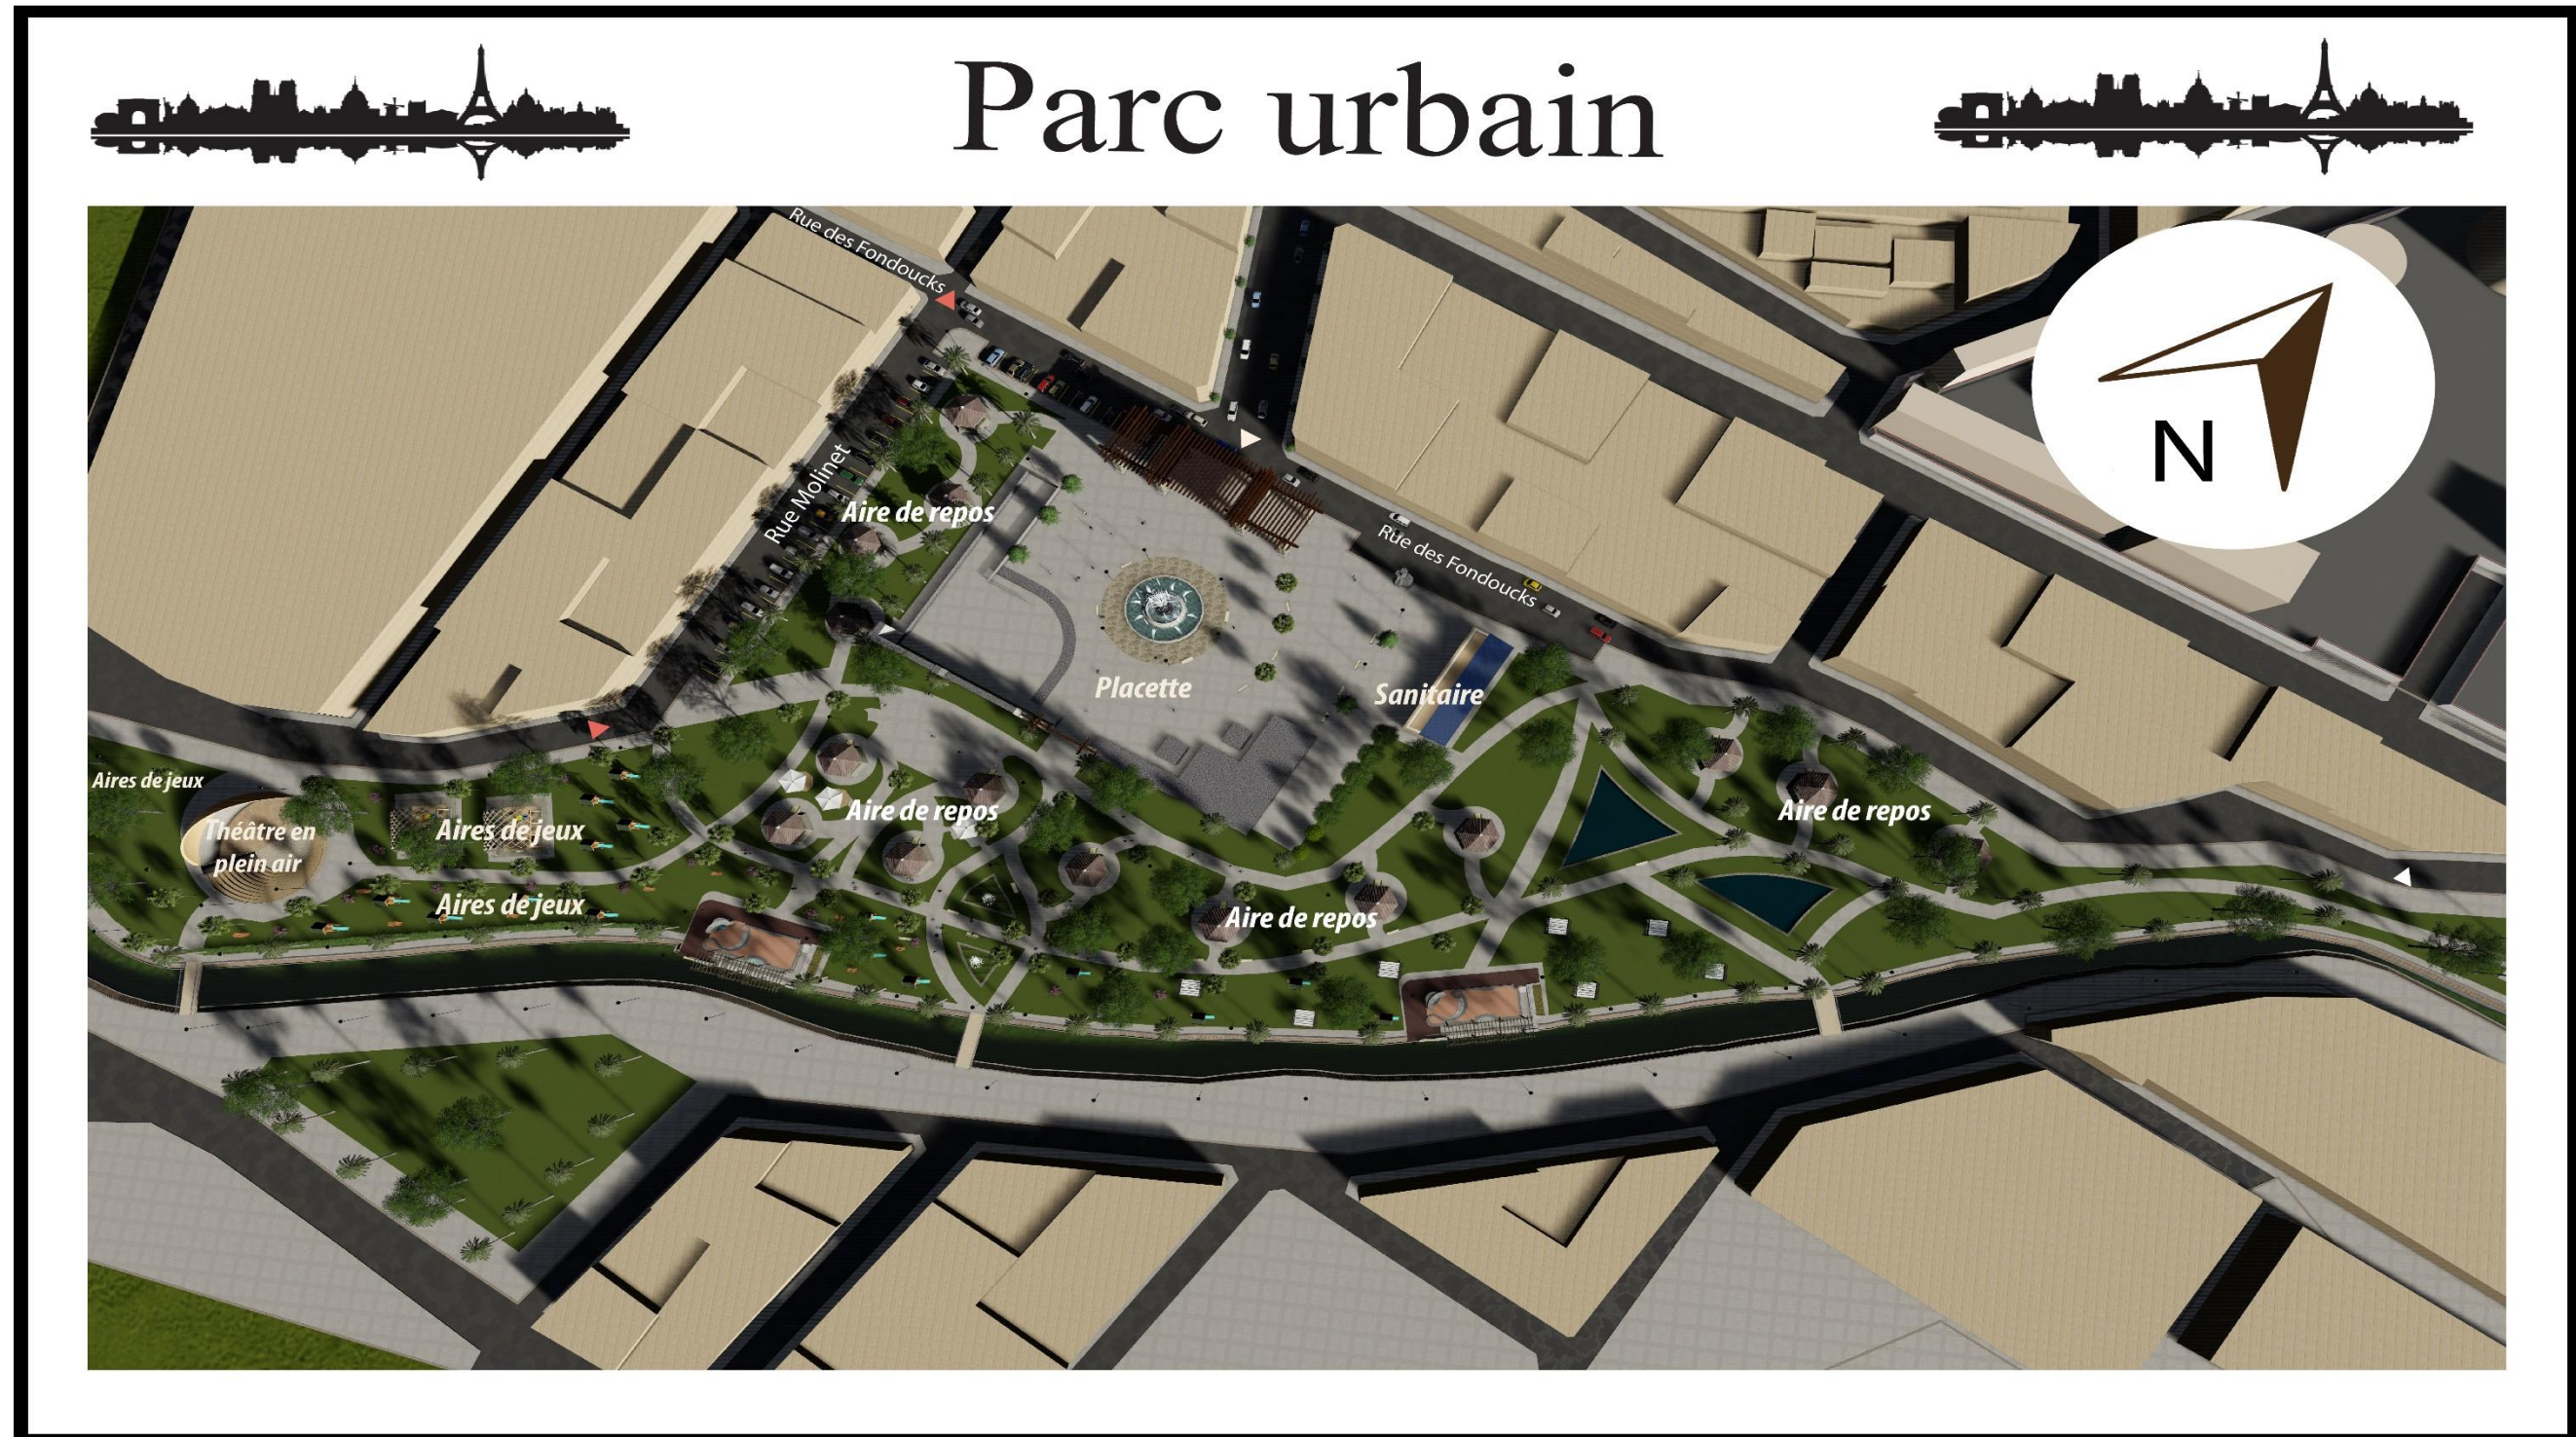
plan d'aménagement parc urbain. Source: Auteurs.
